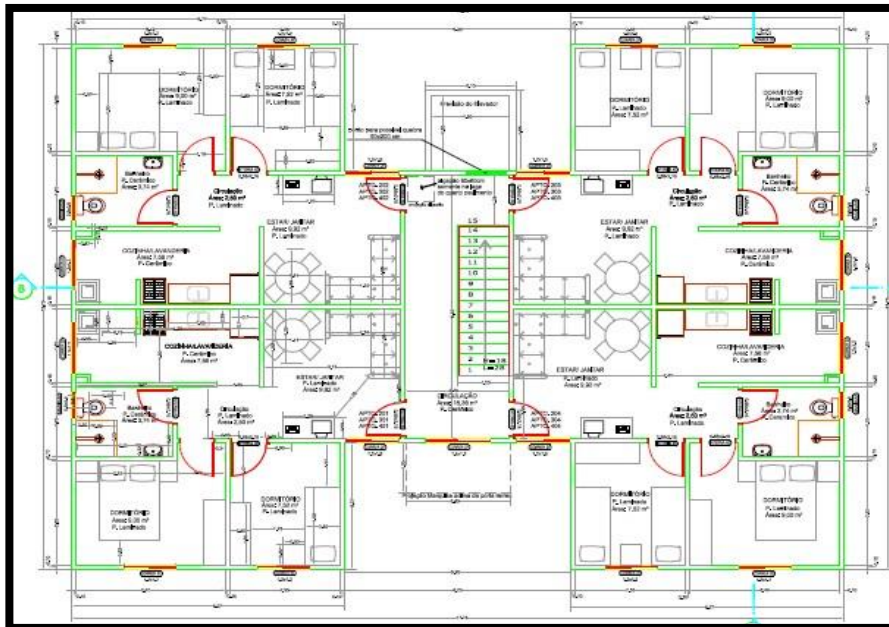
Planta Baixa Residencial San Inácio. Fonte: Construtora Leal.
